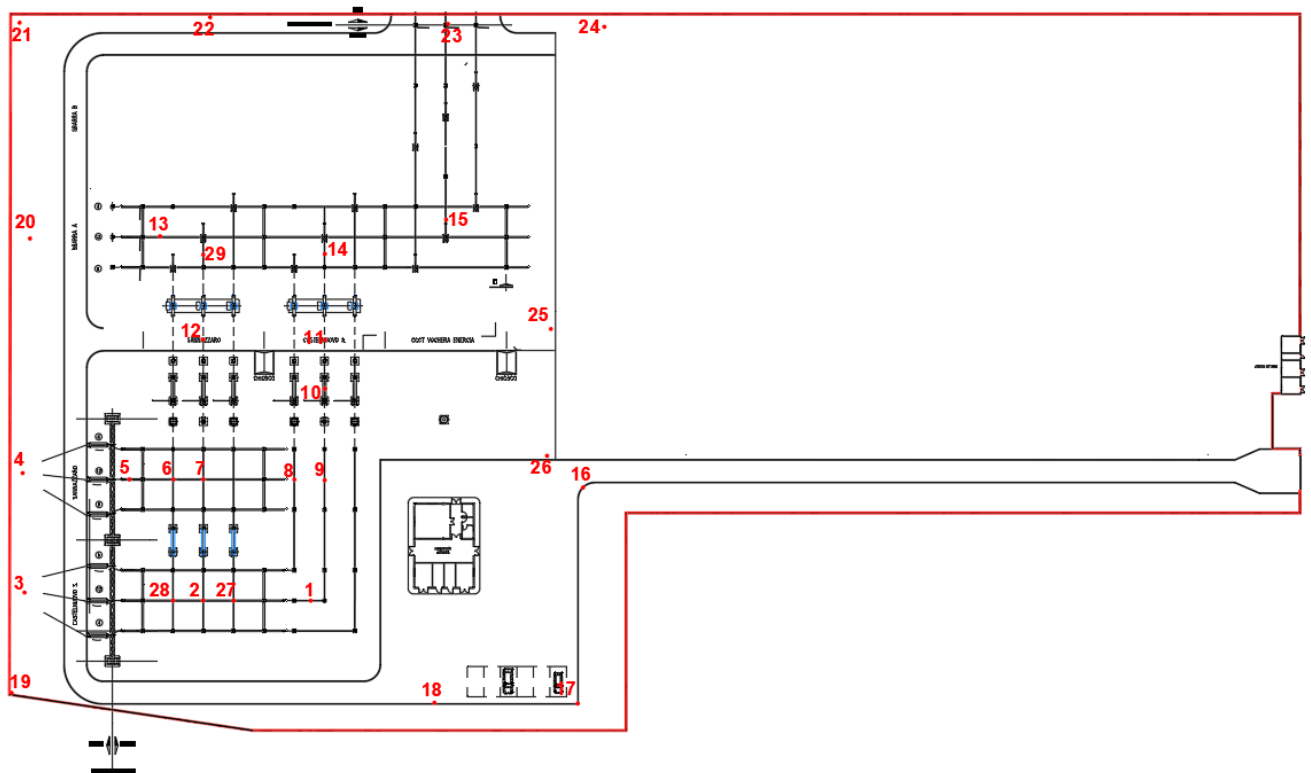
Planimetria della stazione 380 kV Voghera esistente
